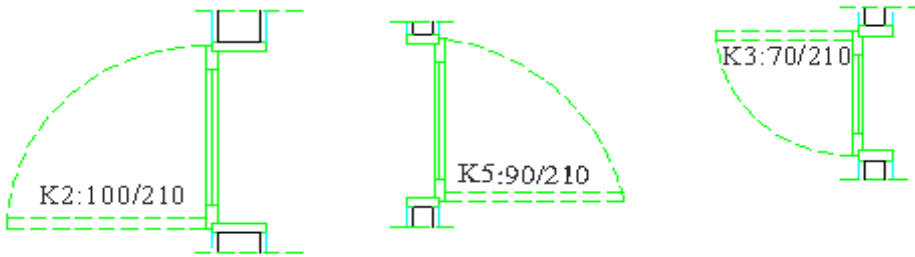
Çelik kapı planında kapı kanadının çizimi
